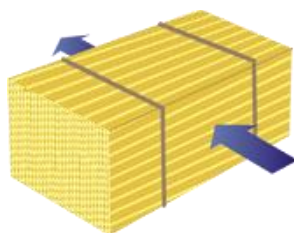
Disposición de las balas de paja. Fuente: waldland⁷⁸
